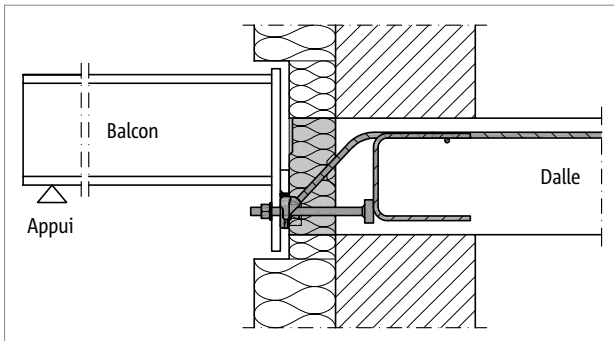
Schöck Isokorb® T type SQ : passage sans obstacle grâce au décalage en hauteur
